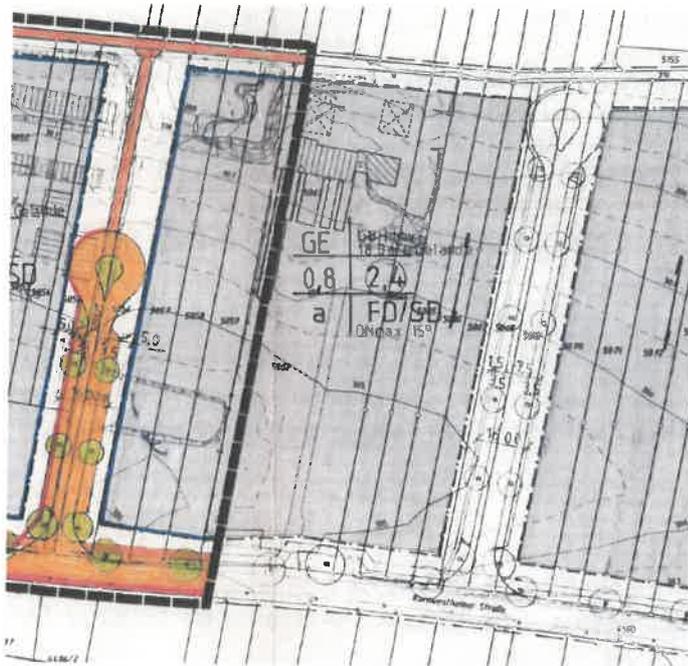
Städtebaulicher Rahmenplan - Ausschnitt
